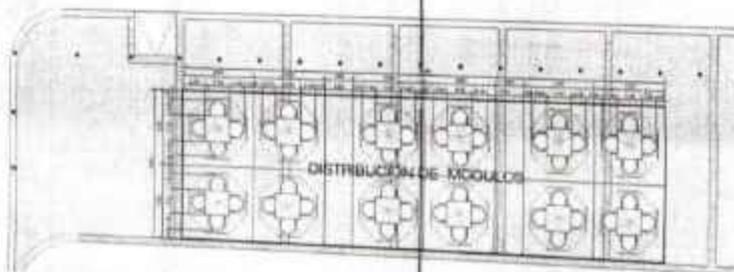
Plano RESTAURANTE TABACO Y RON BAR GOURMET COCKTAILS - Distribución de mobiliario.
